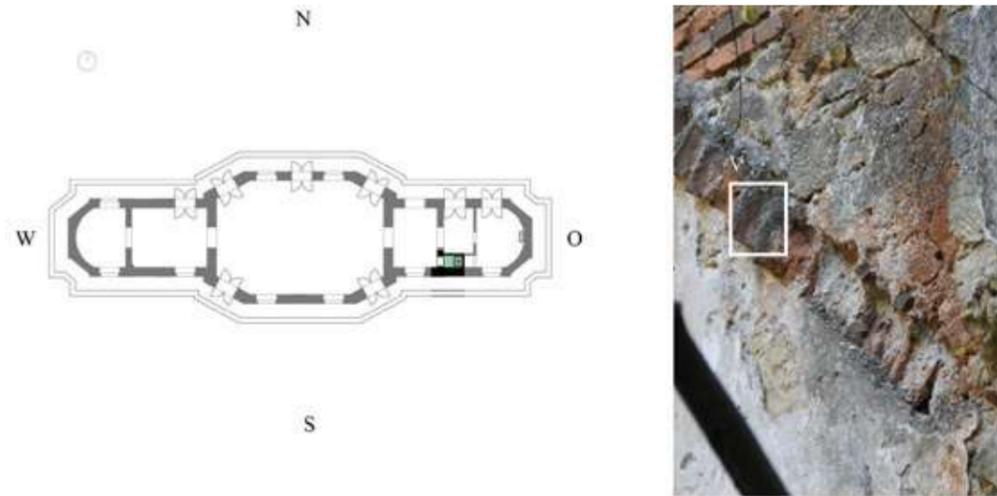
Lage im Grundriss, Detailaufnahme Südwand mit Überresten des ehemaligen Deckenverlaufs
